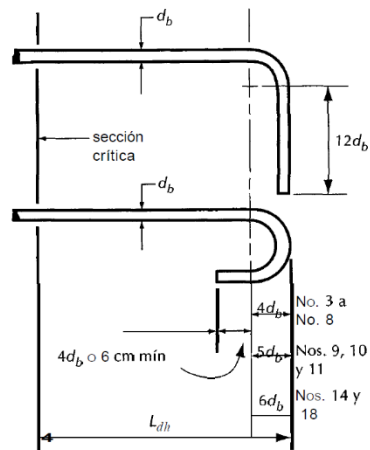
Detalles de ganchos estándar según ACI 318S-14
